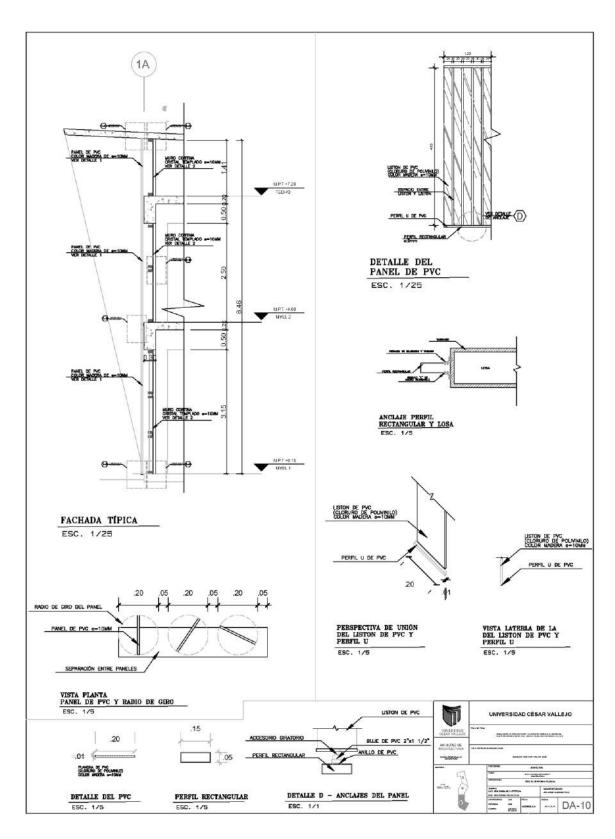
Detalle de fachada - DETALLES ARQUITECTÓNICOS
